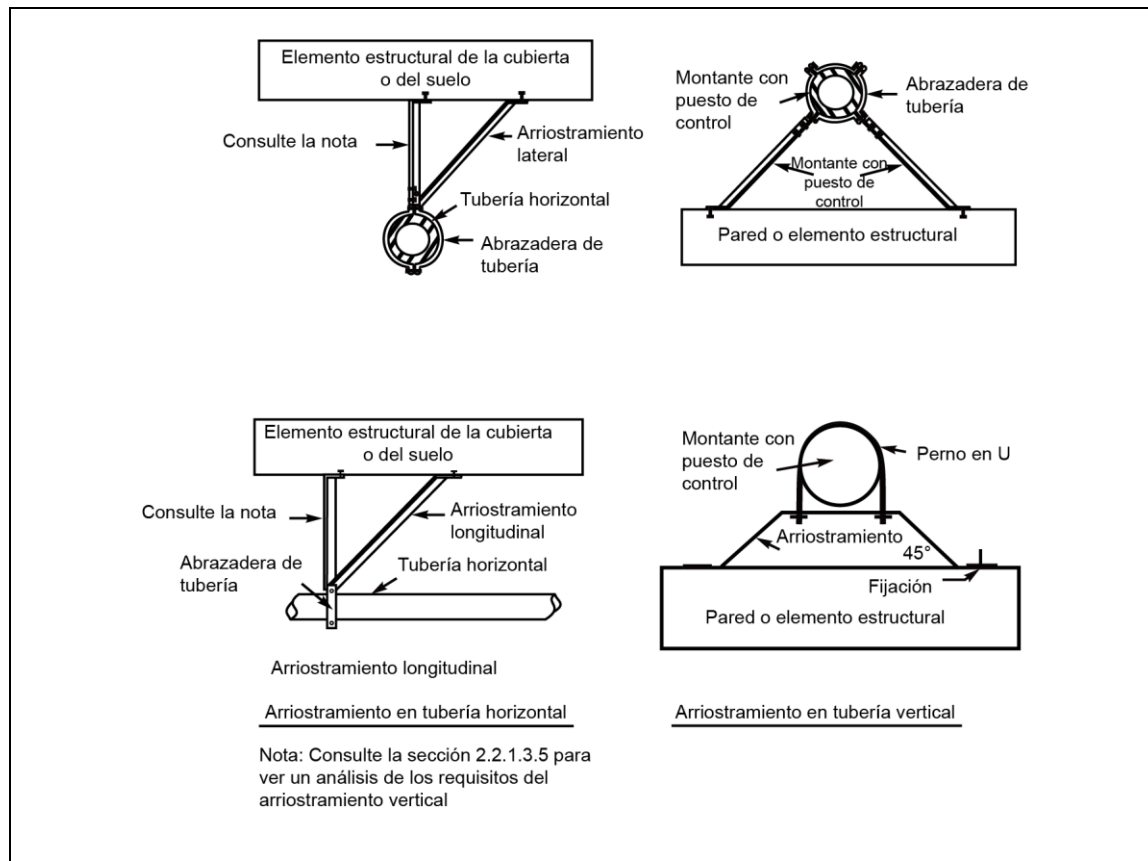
A. Ejemplos de arriostramiento en tuberías horizontales y verticales
